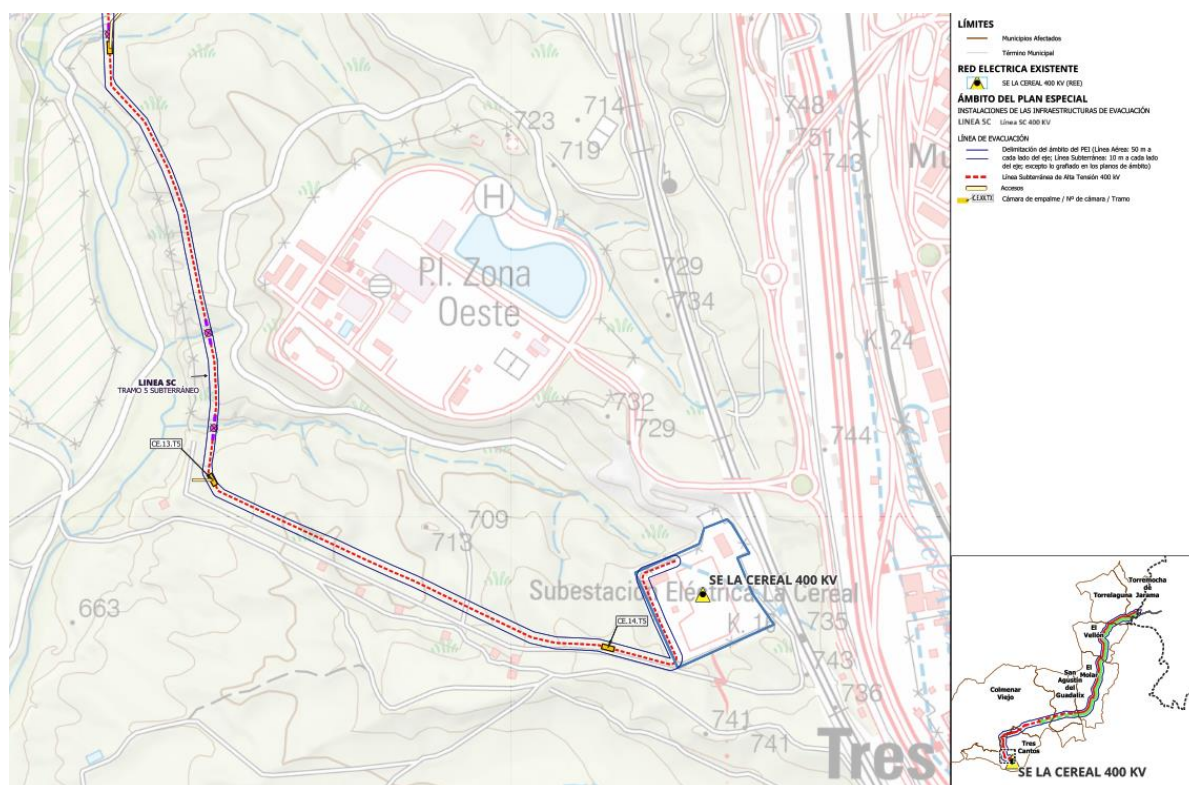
Plano de Ordenación O2.2.7. Planta por tramos. LASAT 400 KV a SE La Cereal 400 KV (REE) – Línea SC
